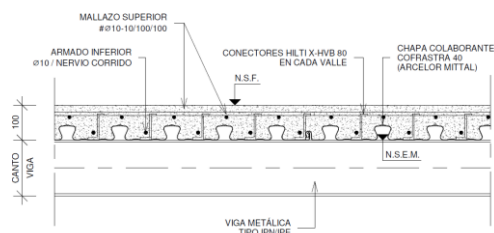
Sección constructiva del forjado colaborante de proyecto.
